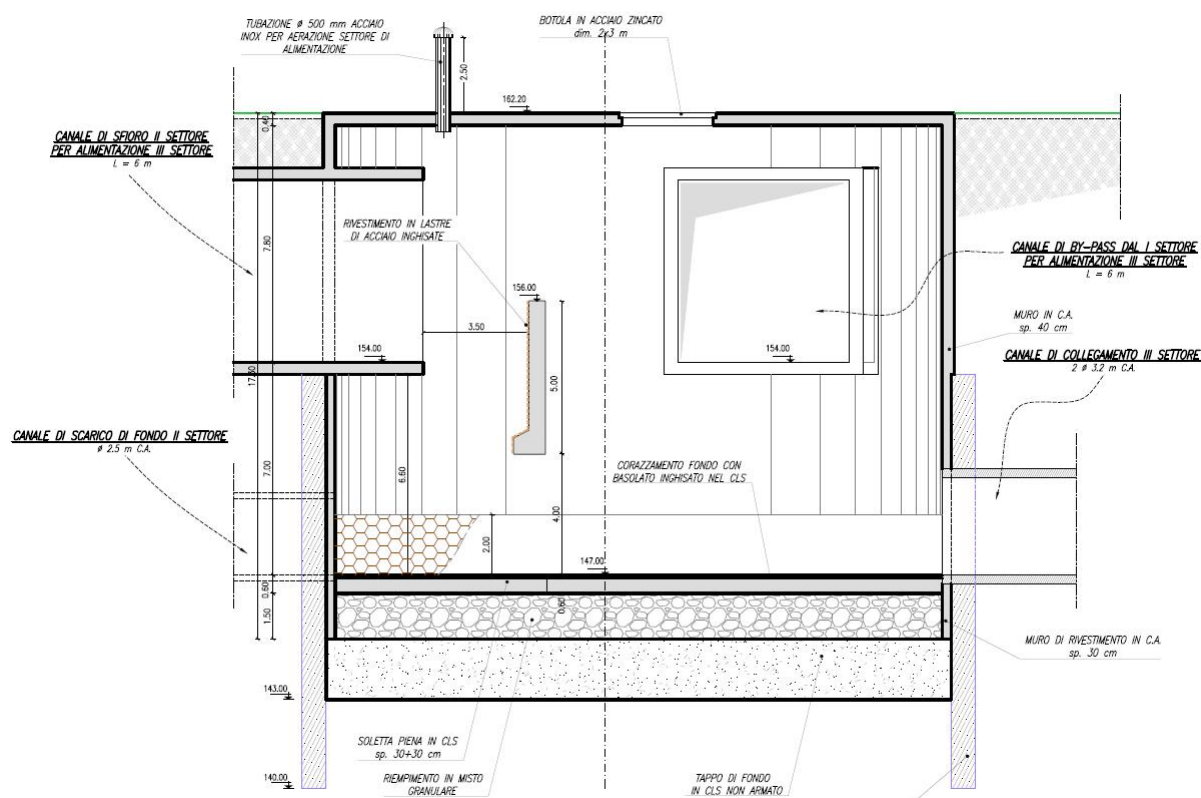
Sezione longitudinale pozzo dissipatore in corrispondenza del settore che svolge funzione di collegamento tra il secondo e il terzo settore.
